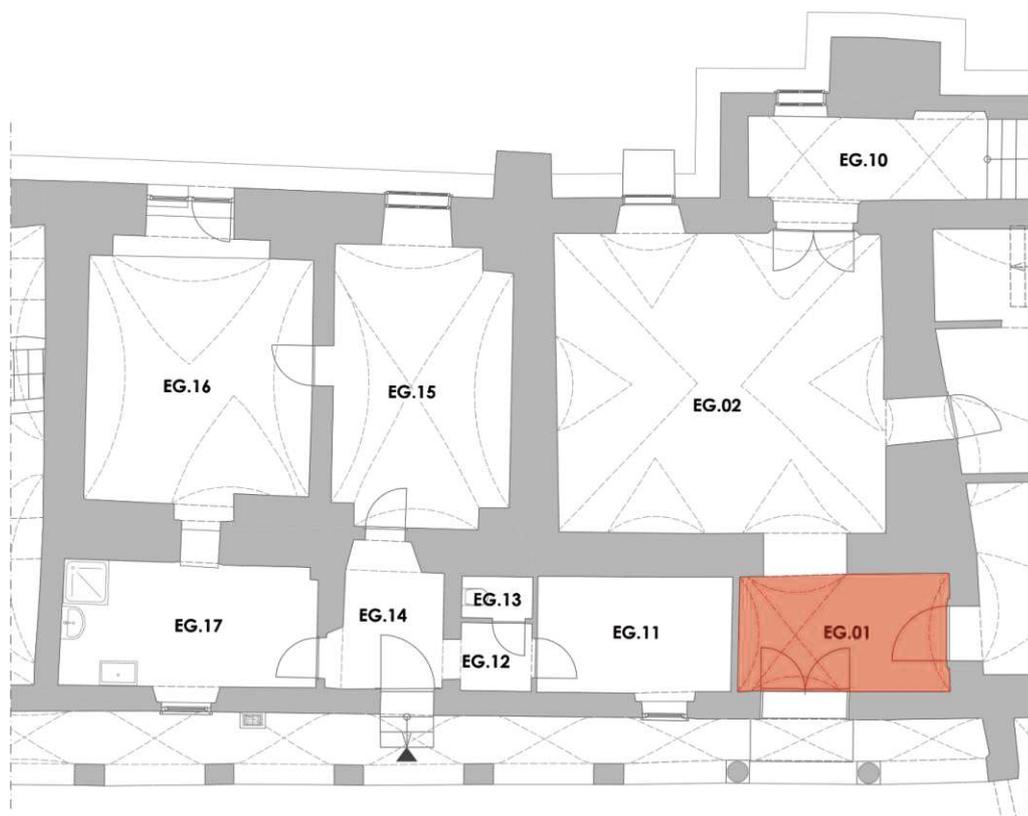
Erdgeschoss Übersichtsplan- EG.01
